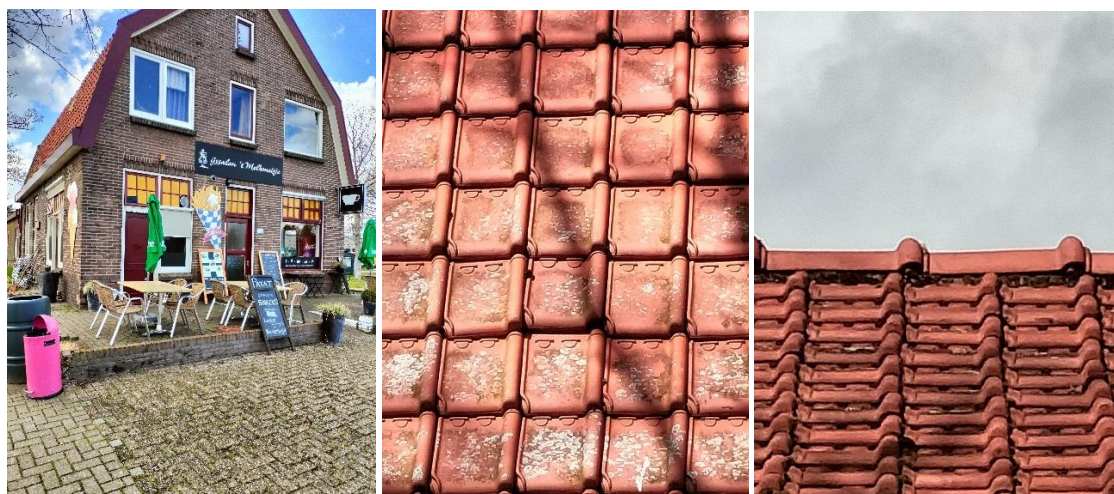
,2,3 ijssalon 202 B heeft strak sluitende dakpannen, nok is afgedicht met cement.
